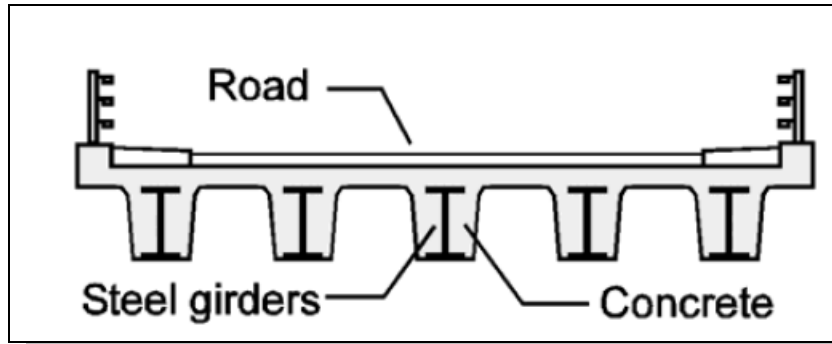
Jenis 5, *Steel Beam and Buckle Plate
